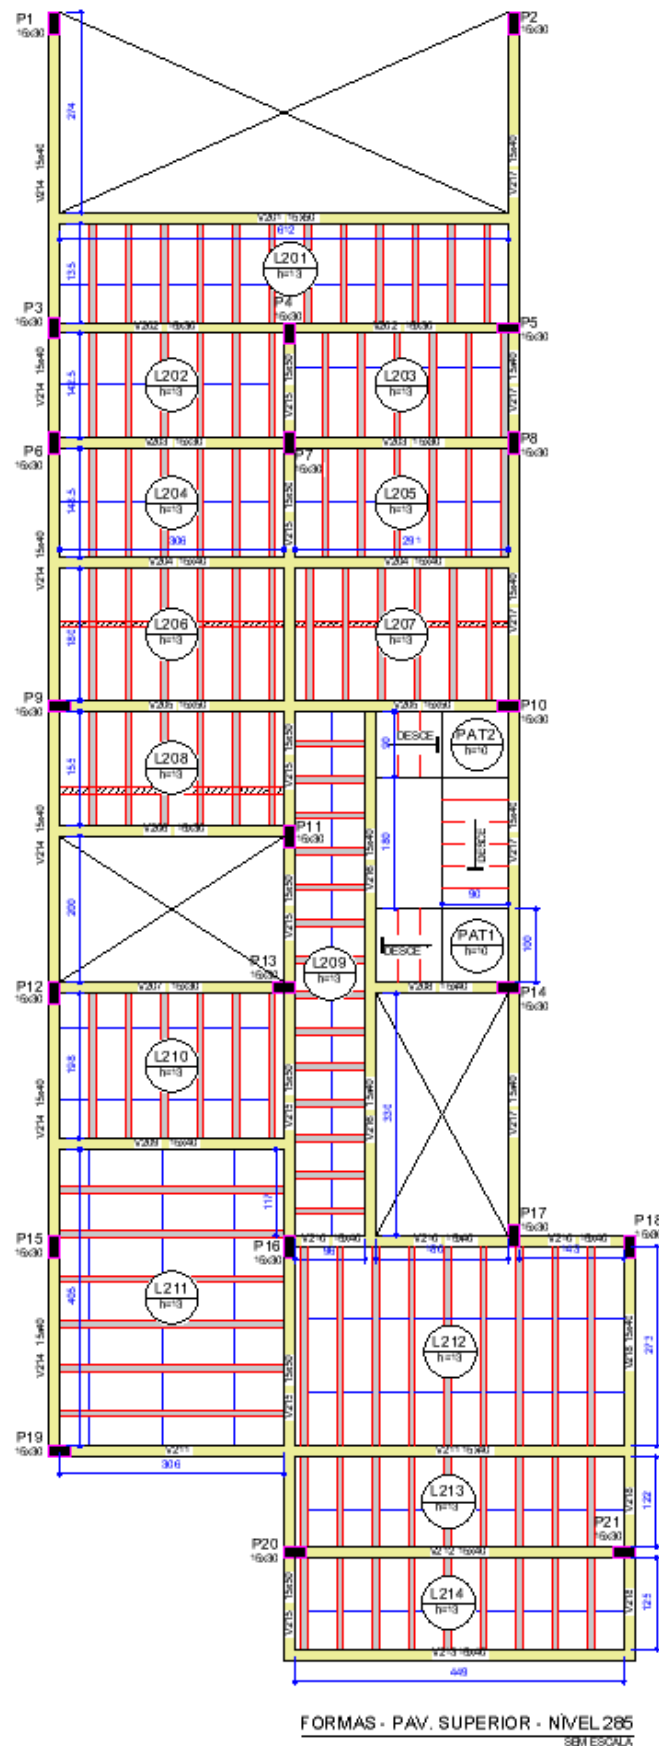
Planta de formas do pavimento superior do modelo de lajes maciças.
